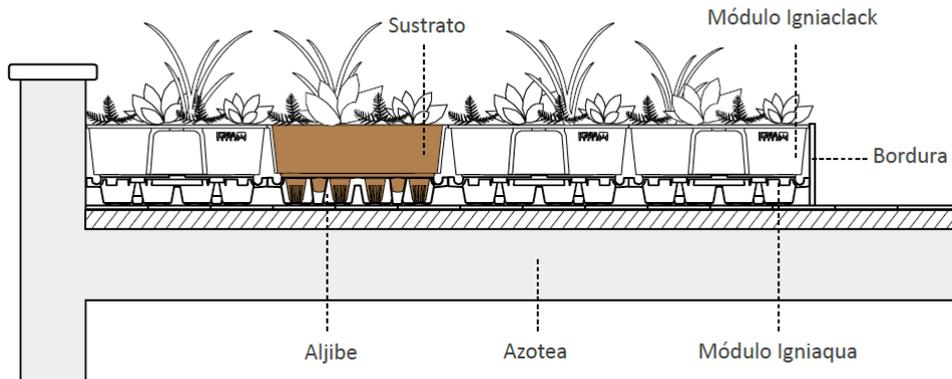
Sistema IGNIAGREEN colocado en azotea [8]
